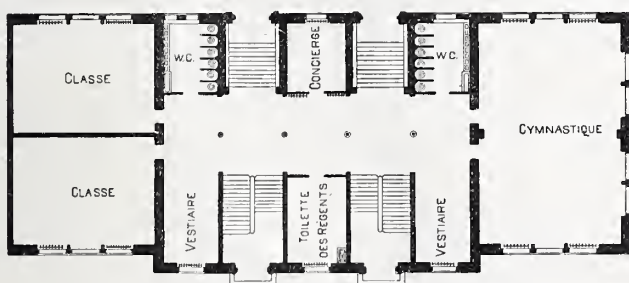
Plan du Rez-de-Chaussée. — Echelle 1:500.
